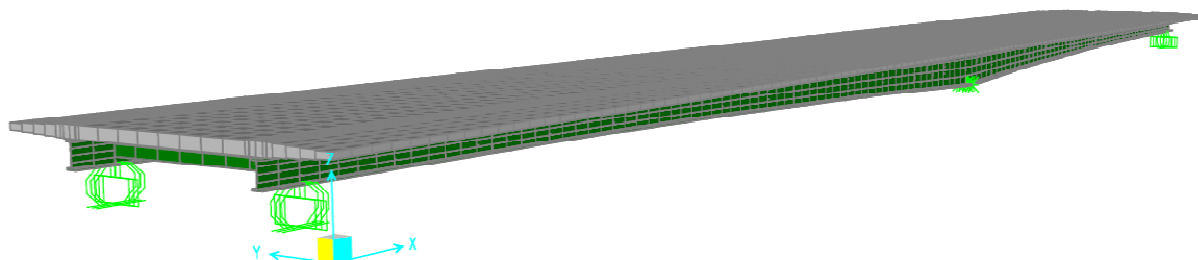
Modelo final do tabuleiro de betão, juntamente com a estrutura metálica.
